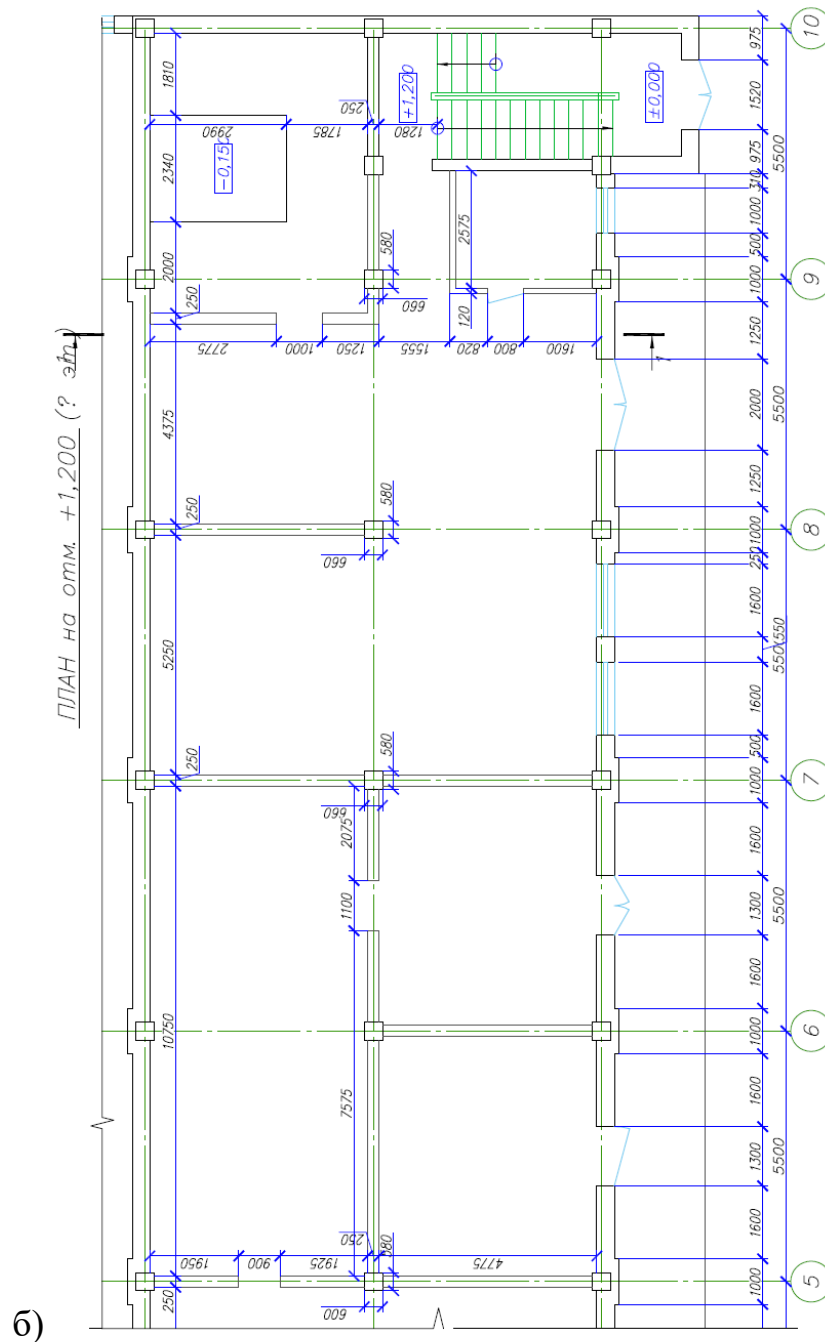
План будівлі на відм. 1,200. Фрагмент б
